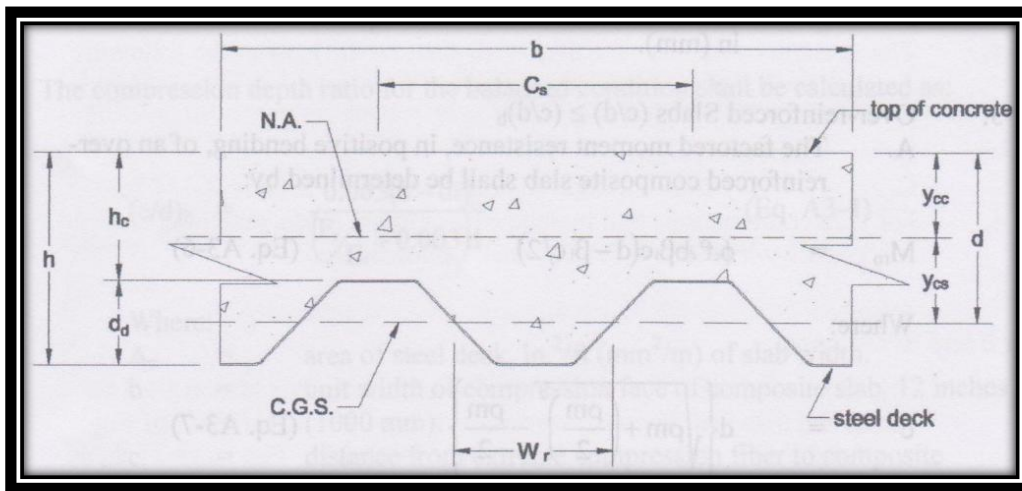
16 Sección de la Losa Compuesta. Referencia 6.
